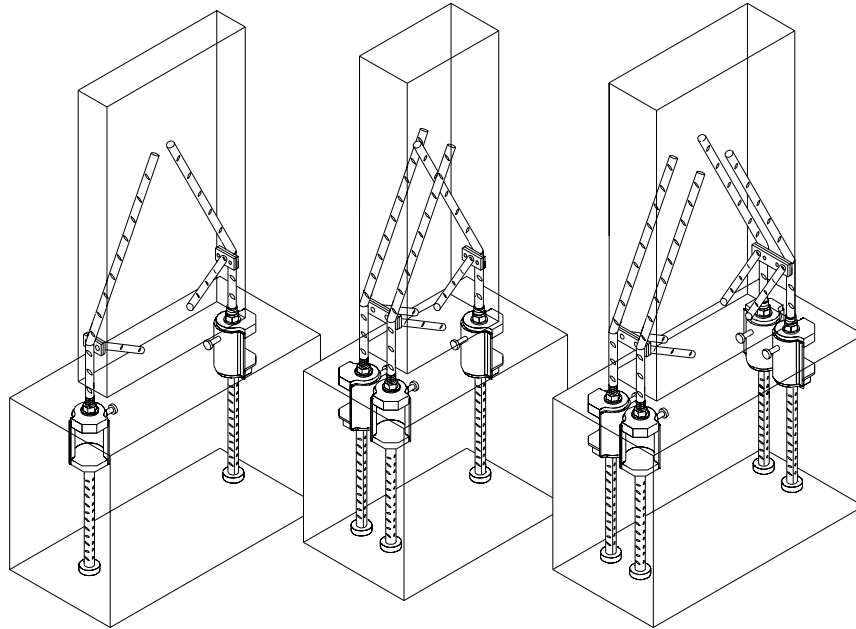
Verbindung zwischen Stützenfuß und Betonfundament mit eingeleimten Stahlstäben. Standardisierte Stahlkomponenten werden im Werk mit dem Holz verleimt, und bekannte Stahlkonstruktionstechnologien werden vor Ort für die Verbindungen verwendet
